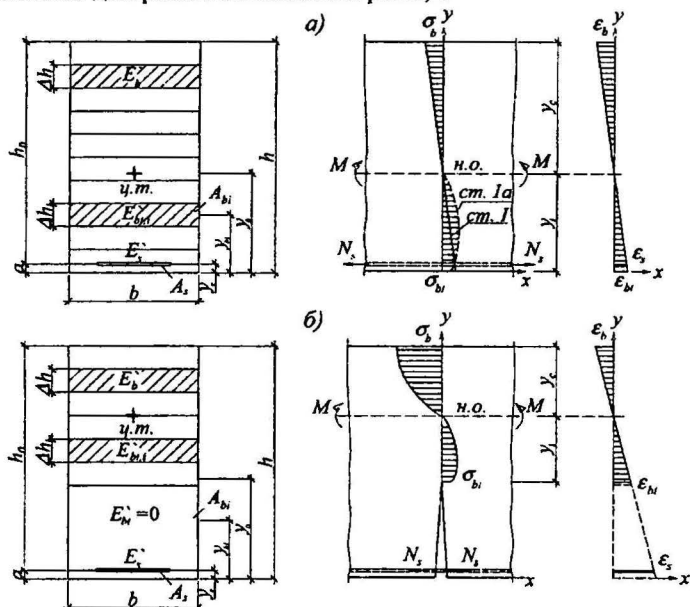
Расчётная схема нормального сечения изгибаемого железобетонного элемента: а – на стадиях I, Ia; б – на стадии II
